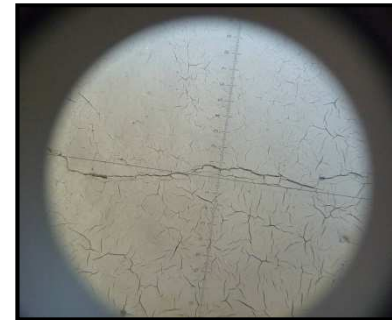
Fisura reparada en el tramo central del PP con sellado
